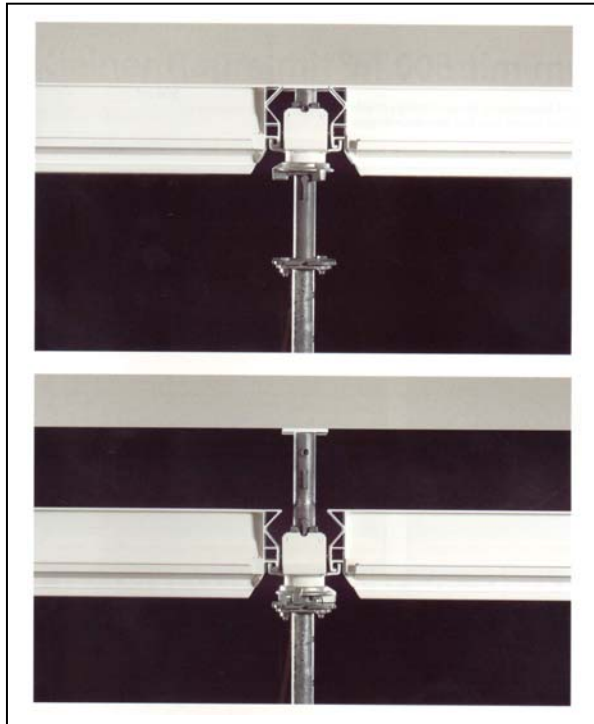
Detalhe do sistema *drop head* da Meva. Acima o dispositivo armado sustenta a laje. Embaixo, quando se desarmar o *drop head*, as vigas (horizontais) descem, liberando o escoramento da laje.
